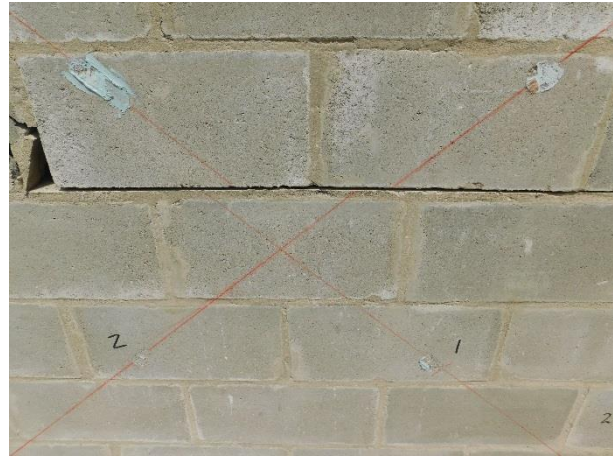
Fisuración y modo de falla del muro MD-2#5/40
